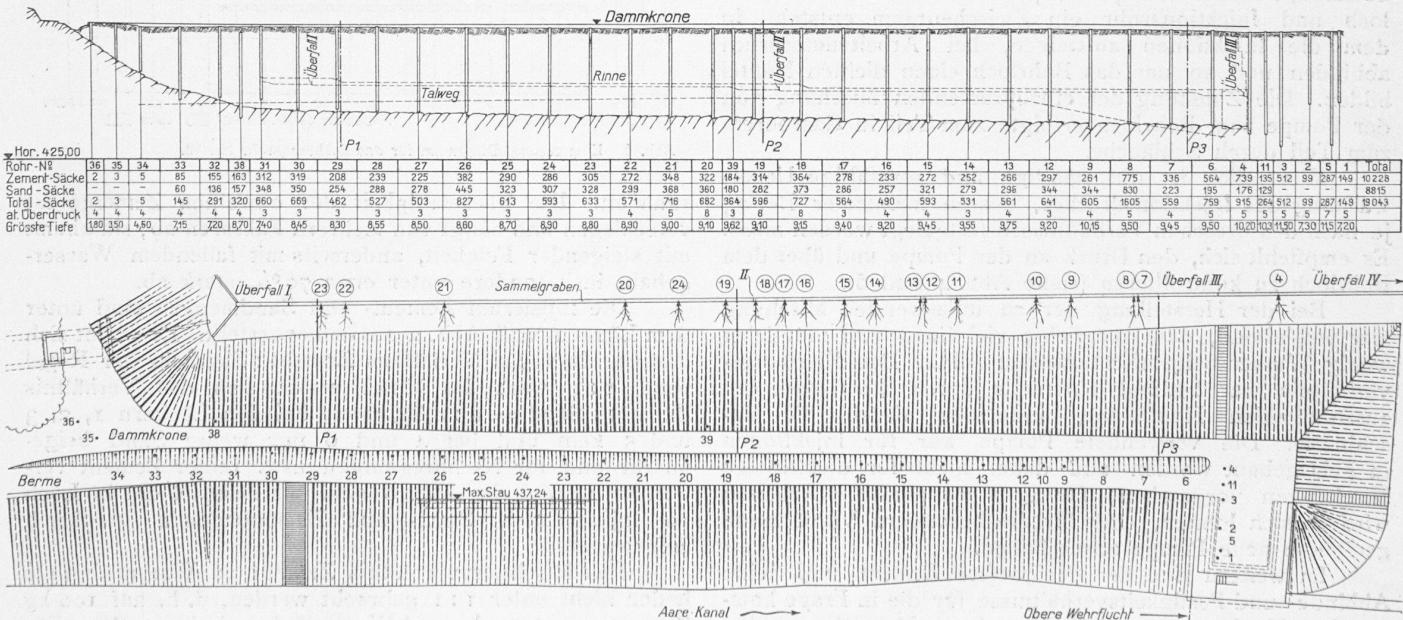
und 3. Längsschnitt und Grundriss der gedichteten Dammstrecke, mit Eintragung der Injektions-Bohrlöcher. — Maßstab 1 : 700.
